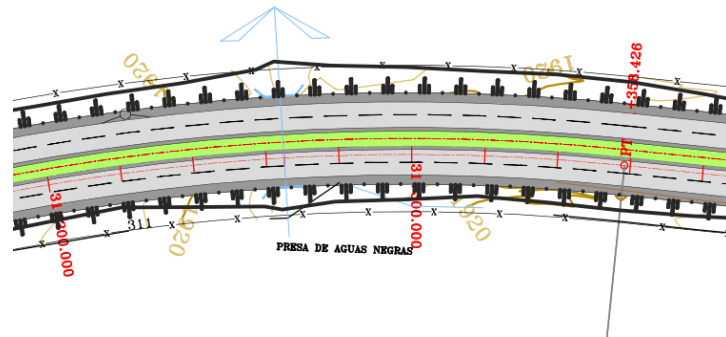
Ubicación de Obras de Drenaje en la Planta de Kilometro
